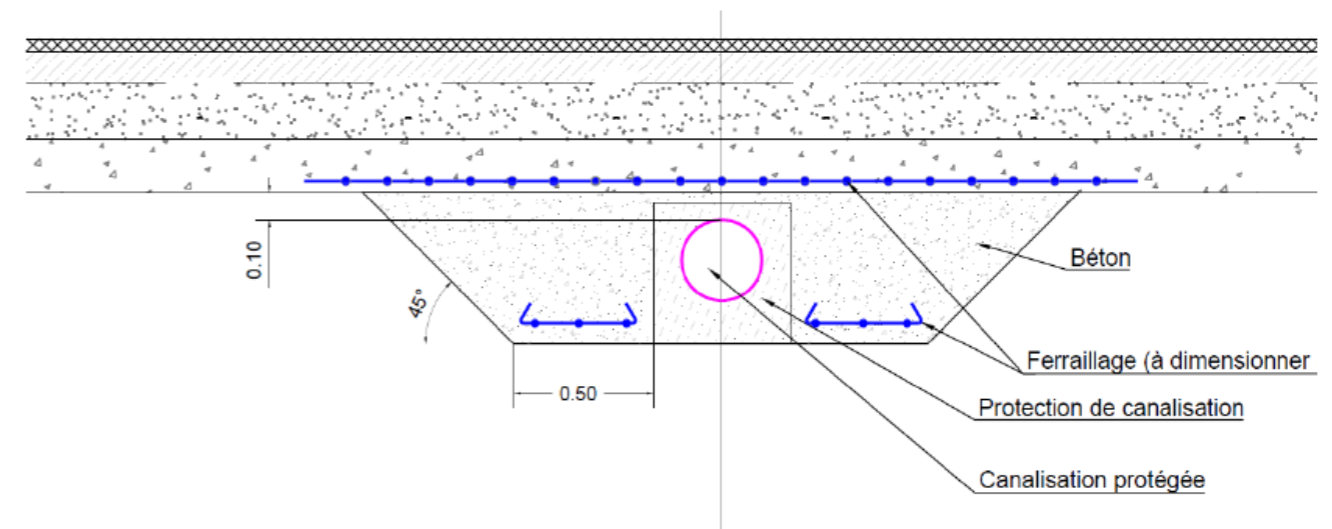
coupe longitudinale de plateforme sur zone de pontage d'un réseau transversal
